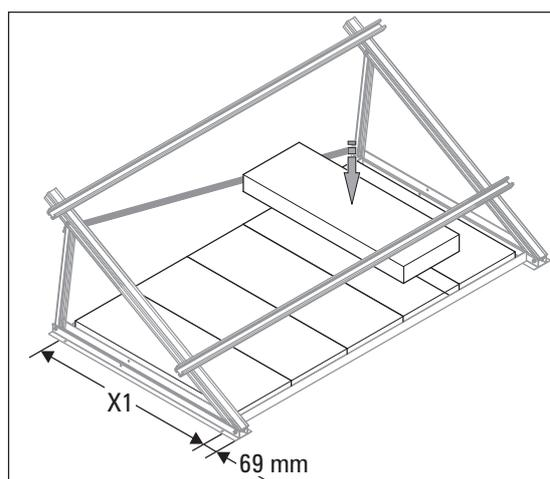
Insertar las losas de hormigón (EKSH26A)
